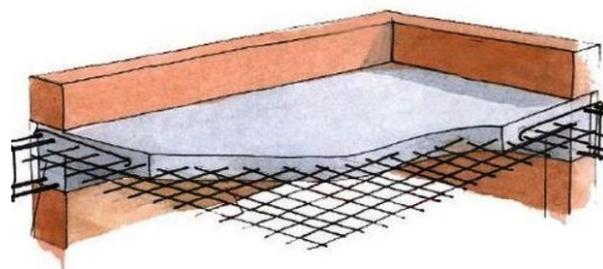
Конструкция безбалочной (плоской) монолитной плиты перекрытия
